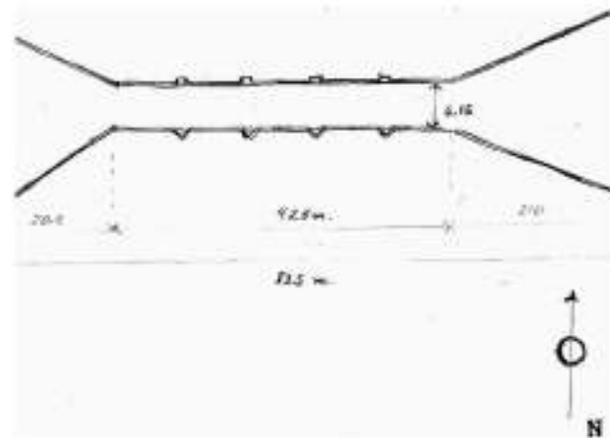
Planta del puente desde el lado sur. Dibujo: G. Bails.
